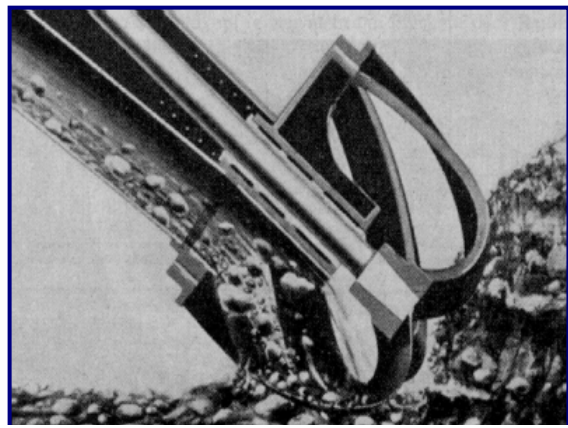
Detalhe da cabeça de dragagem dispositivo de corte e tubo de sucção.
